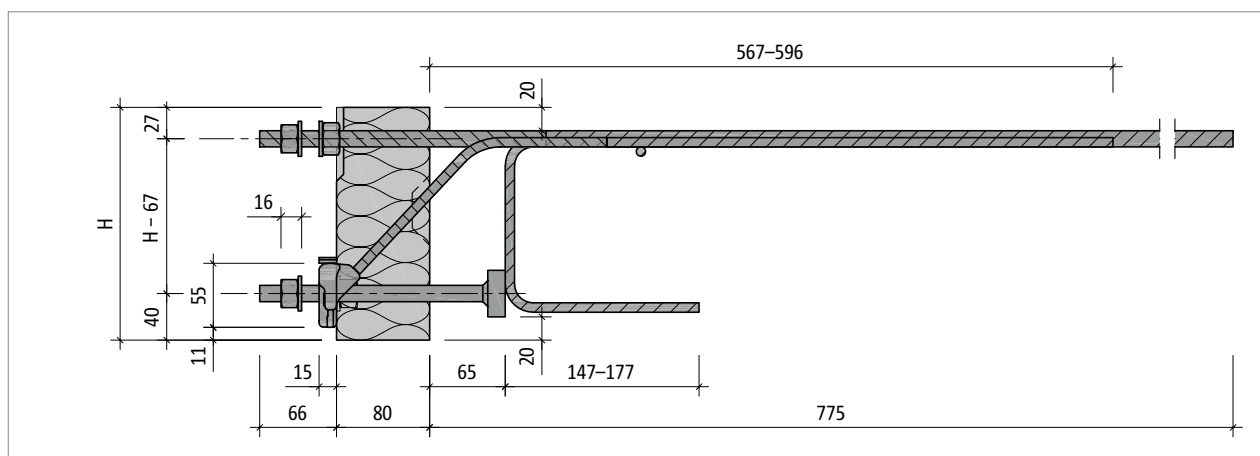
Schöck Isokorb® T type SK-MM2-VV1: Bovenanzicht
